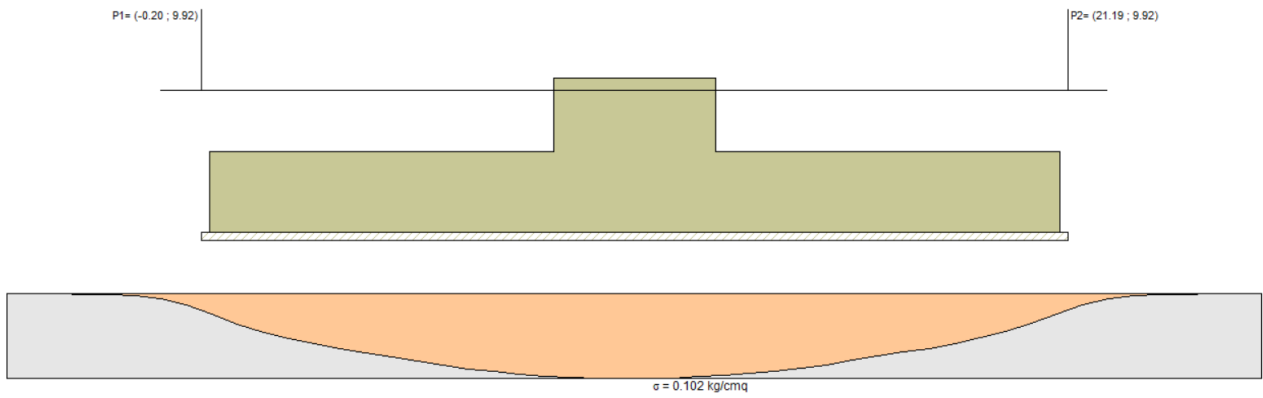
Rappresentazione bulbo di pressione delle verifiche delle strutture di fondazione
